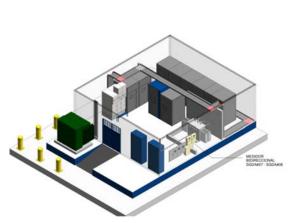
Modelado de cuarto eléctrico SGDA#8 planta baja.
